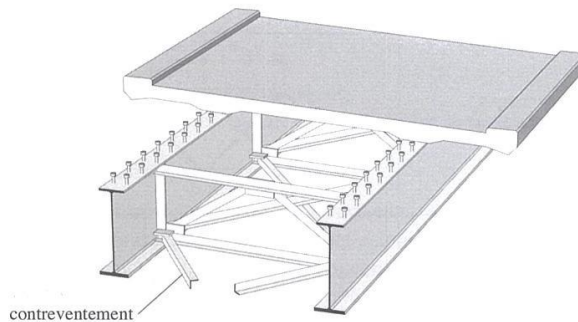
Section mixte ouverte munie d'un contreventement inférieur.
